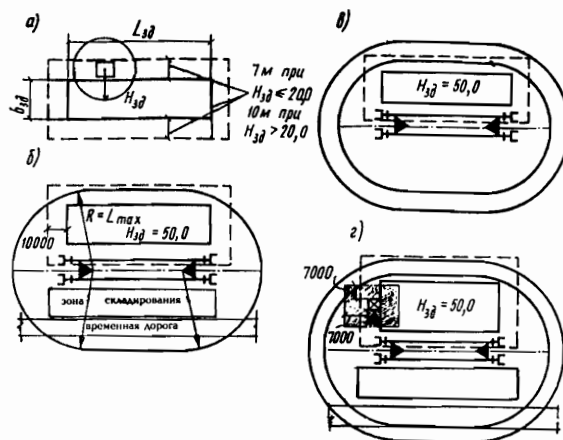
Определение необходимых зон при возведении надземной части зданий башенными или самоходными стреловыми кранами: а – монтажной зоны; б – зоны работы башенного крана; в – зоны перемещения груза; г – зоны работы подъемника
